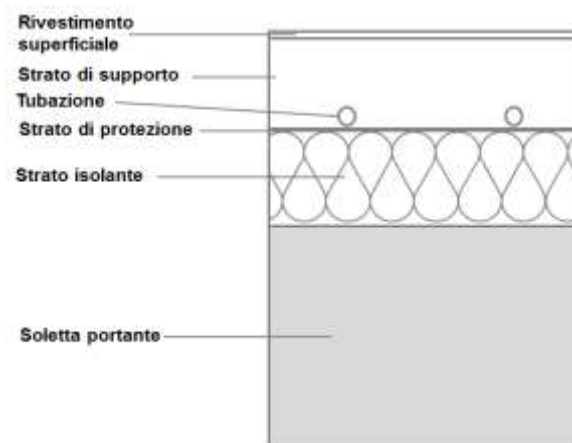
Stratigrafia sistema radiante a pavimento con massetto cementizio.
